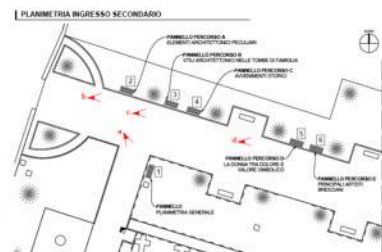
Planimetria parziale dell'ingresso secondario da via Industriale con i render dell'inserimento dei pannelli tattili.
